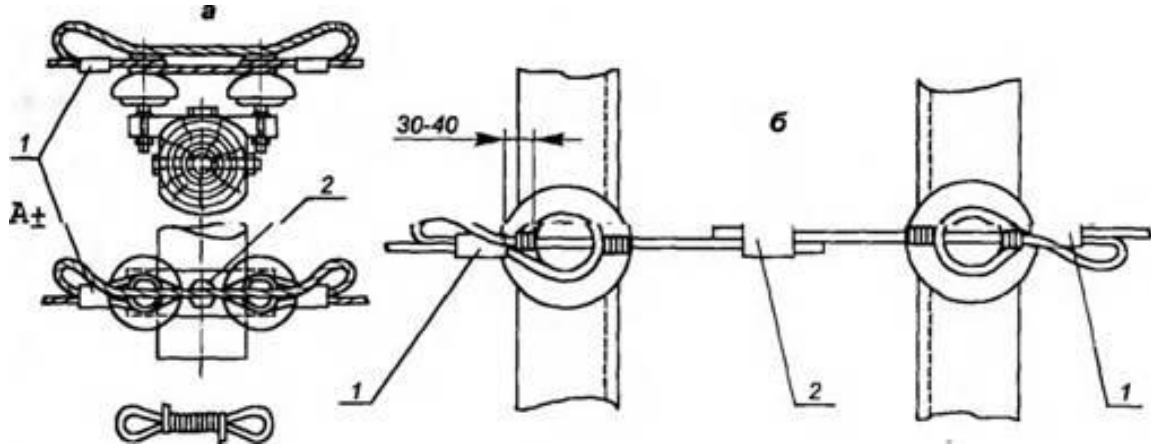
Одинарное усиленное анкерное крепление провода на штыревых изоляторах анкерной опоры:
